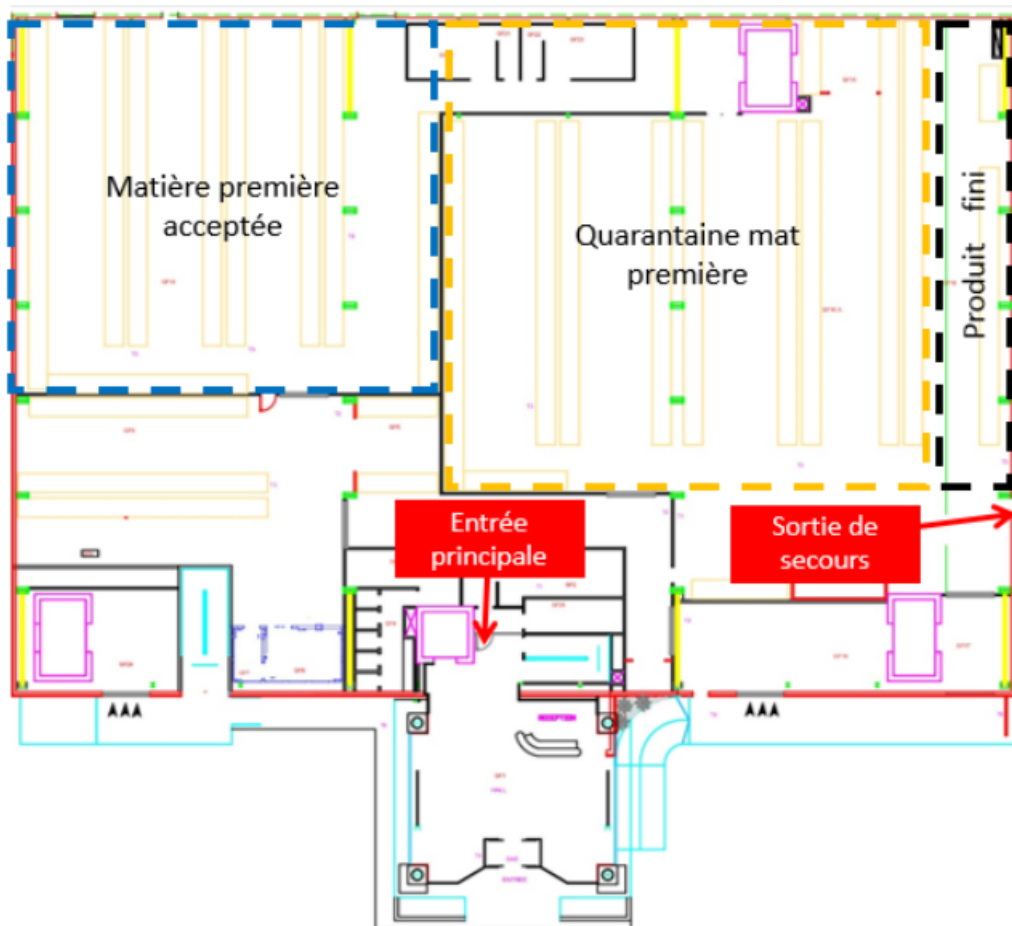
Plan du magasin du rez-de-chaussée
